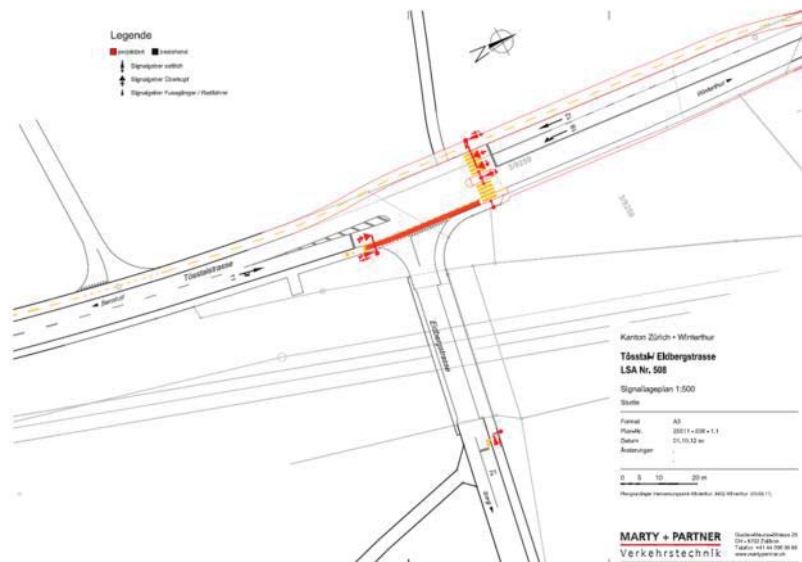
Signallageplan LSA Nr. 508 (vgl. Anhang A3)
